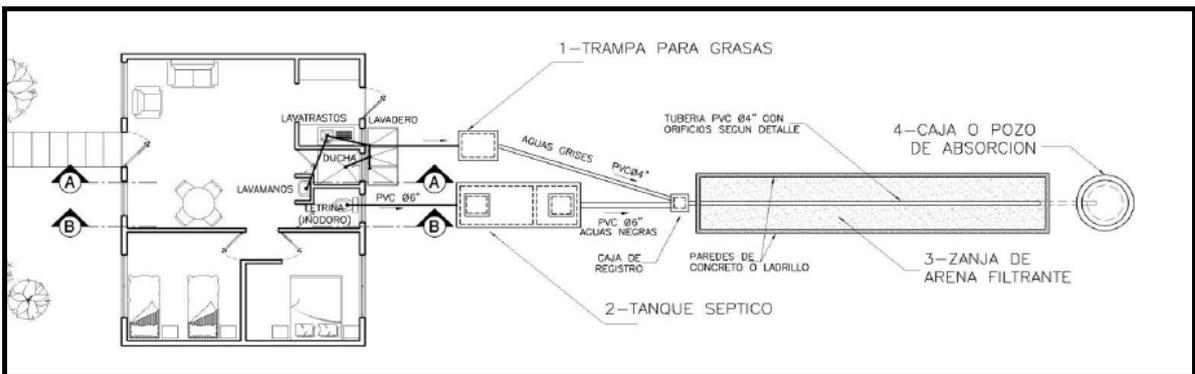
ubicación en planta de tanque séptico y zanja filtrante de arena
